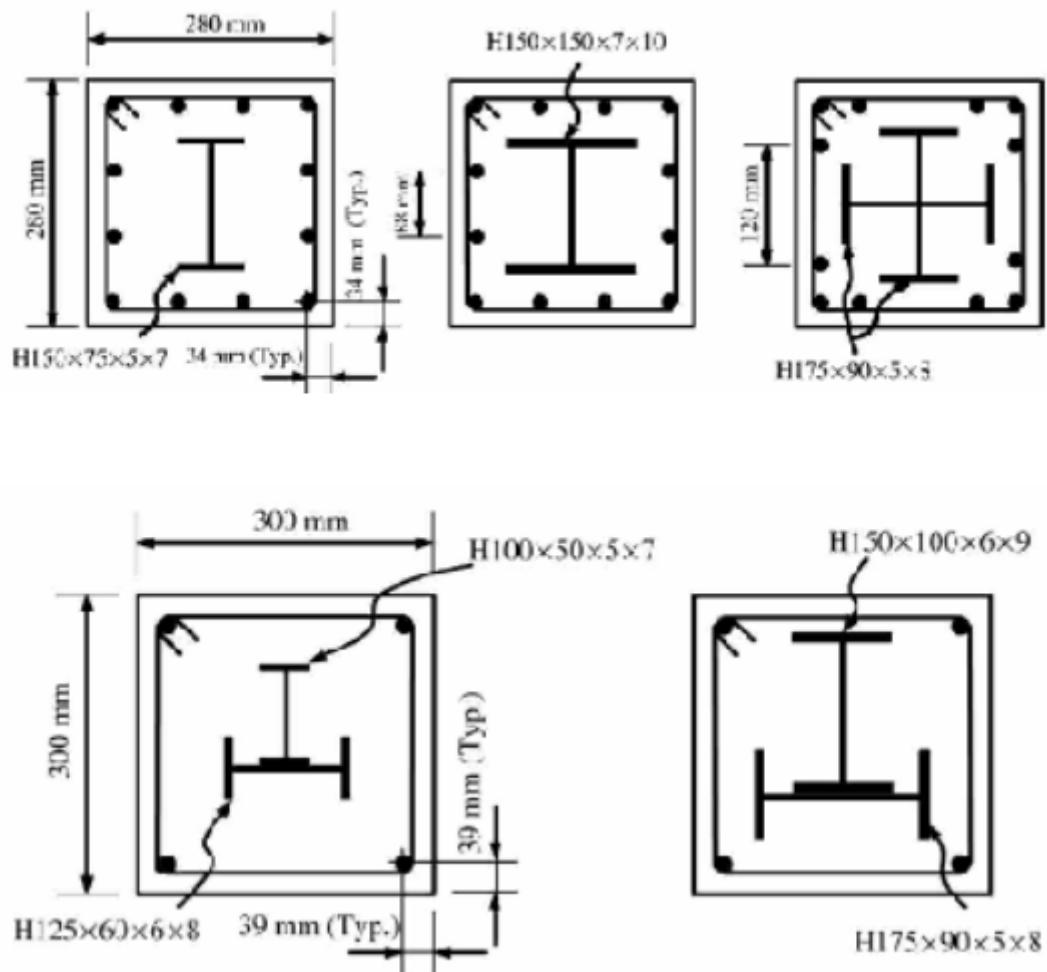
Sections droites des poteaux métalliques en I, ou en H enrobés de béton[50].
